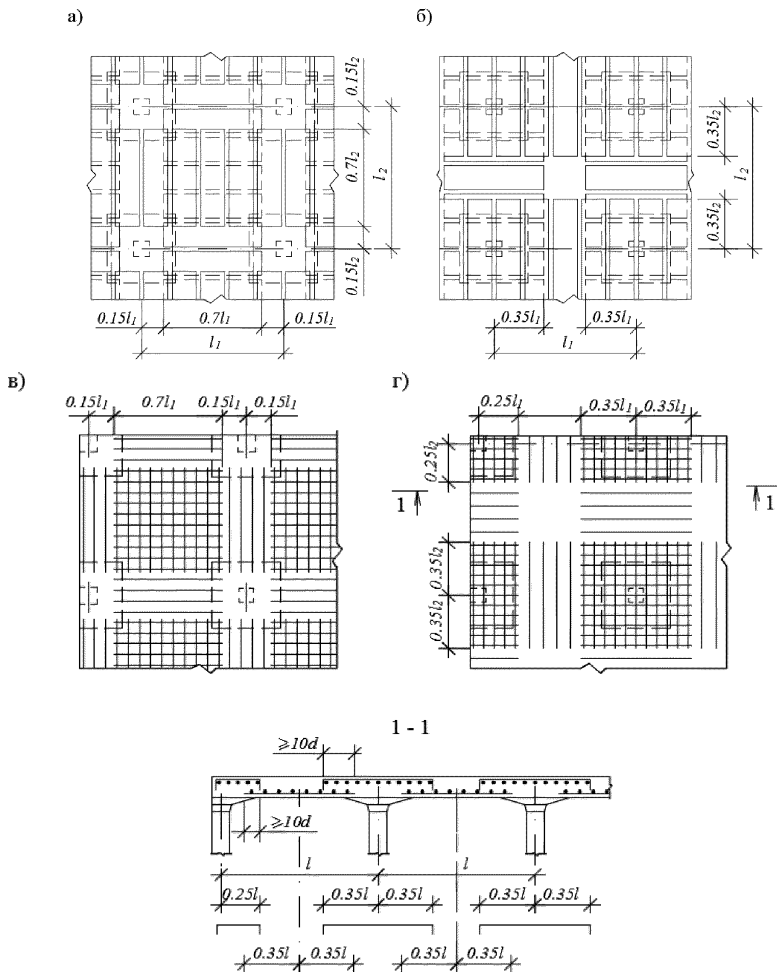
Схемы армирования безбалочных перекрытий
